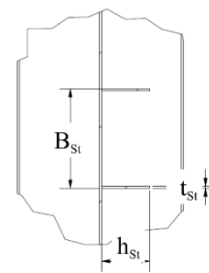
Geometrie und Belastung der Prüfkörper
